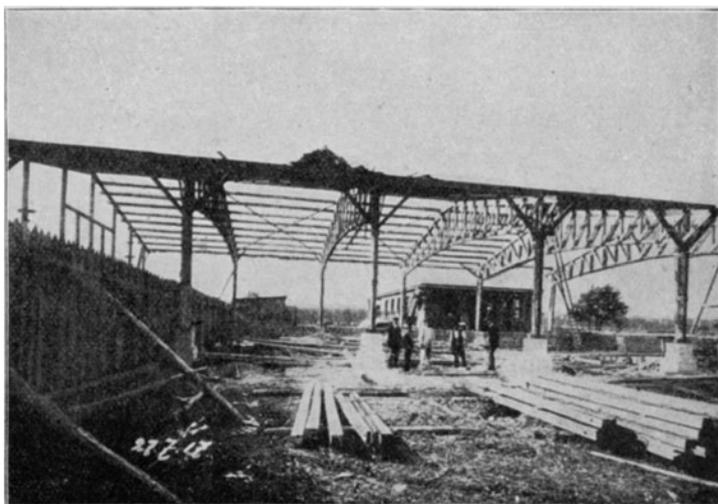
Lagerhalle mit Brettbinderkonstruktionen.
